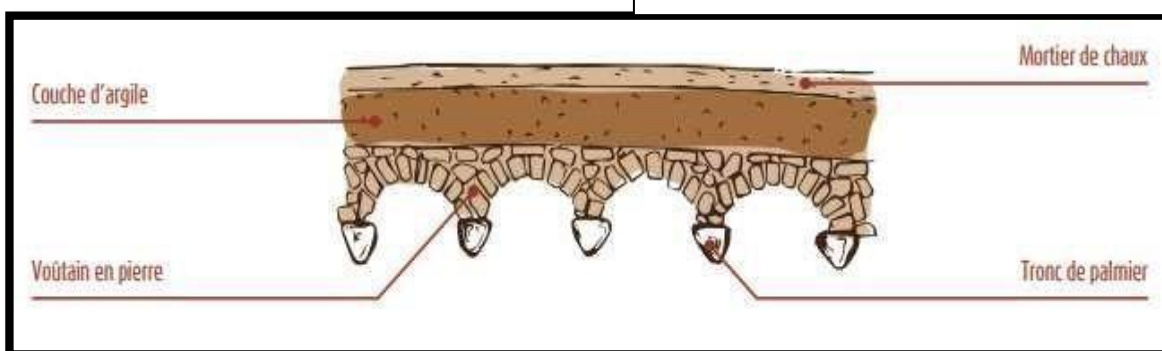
Schéma d'un plancher en troncs de palmiers et voûtains Source : Types_de_plancher_dans_les_constructions_traditionnelles_dans_la_vallée_du_M'zab PDF
